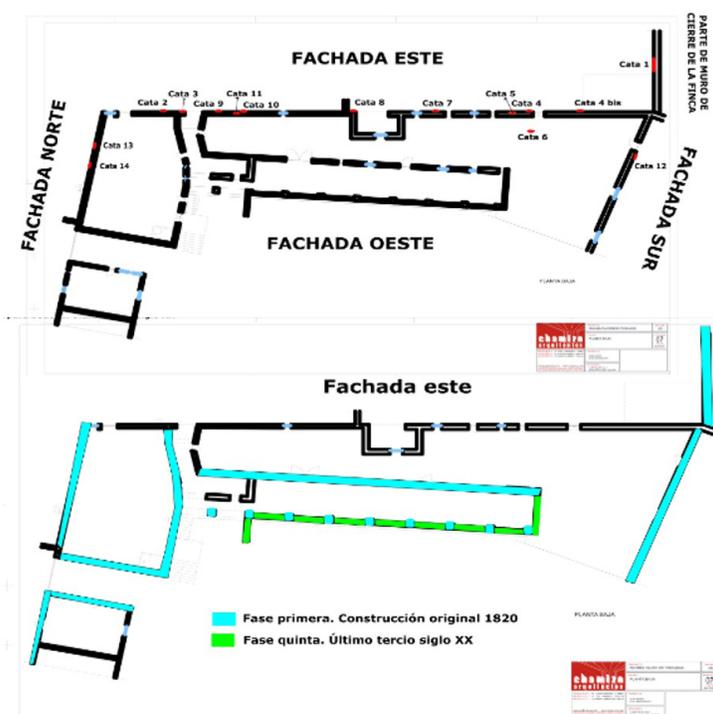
Plano con la ubicación de todas las catas realizadas, arriba. Plano con la cronología de los muros, abajo.
